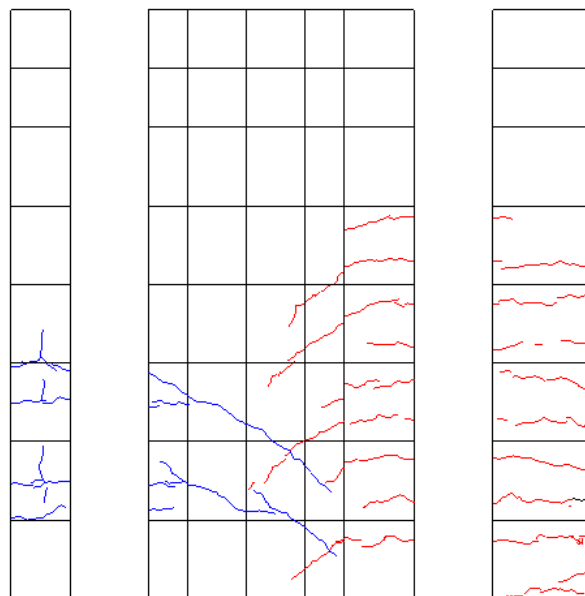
R=1/400②ひび割れ図
